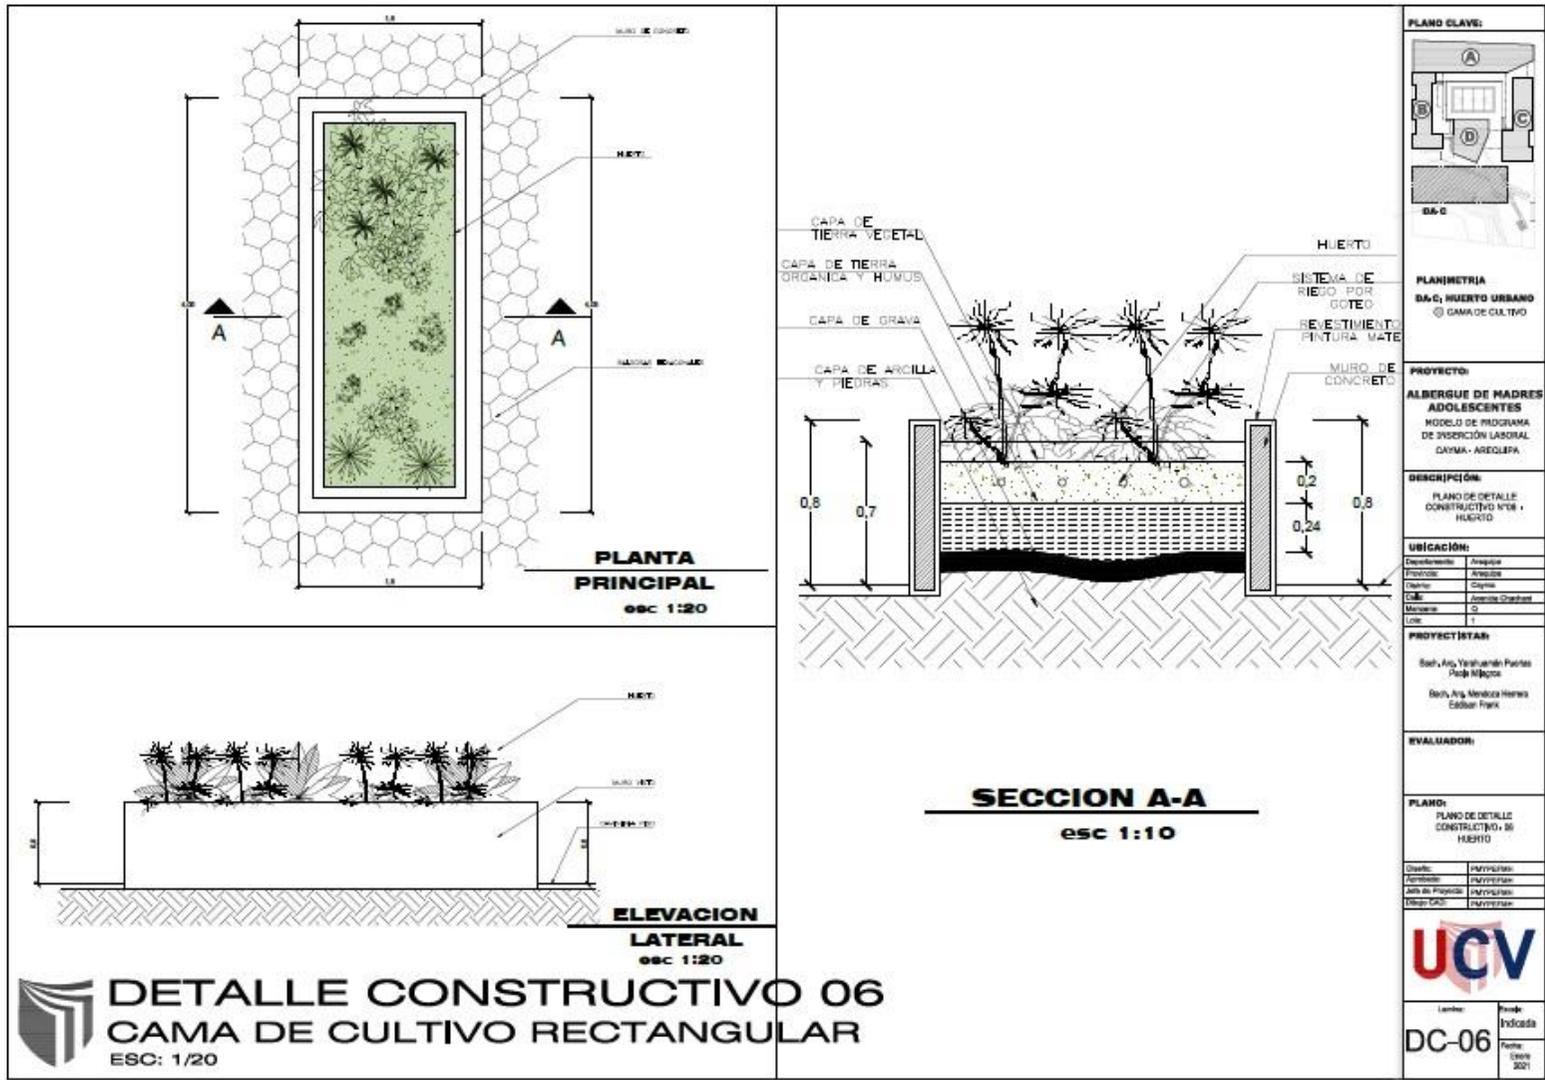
Detalle Constructivo 06 – Cama de Cultivo Rectangular DC-06.
